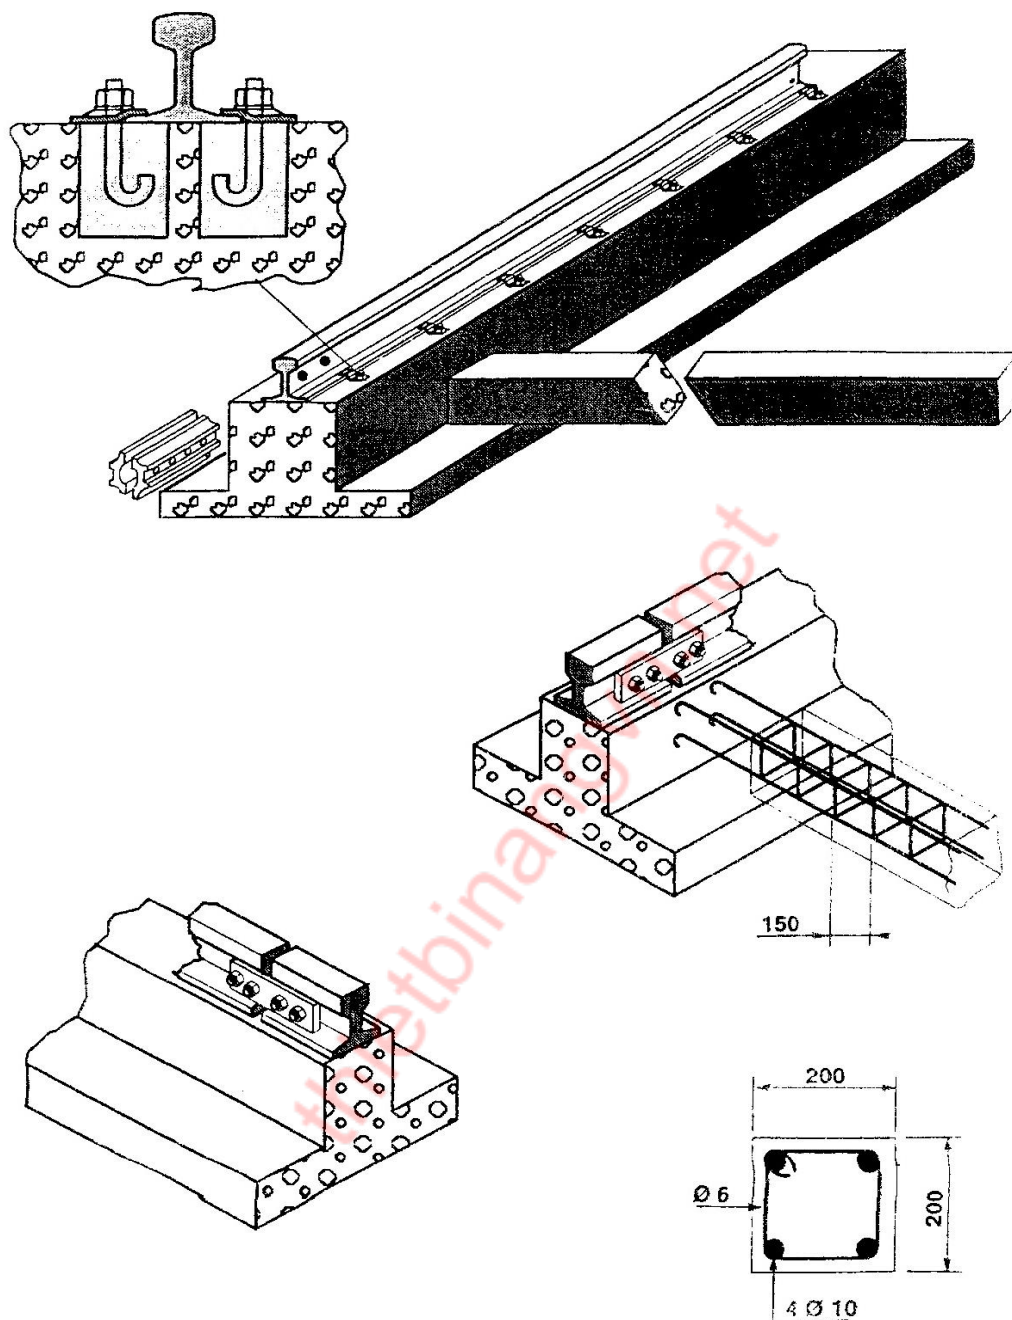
混凝土轨枕的连接 Fig. 2-13 The concrete sleepers connection
